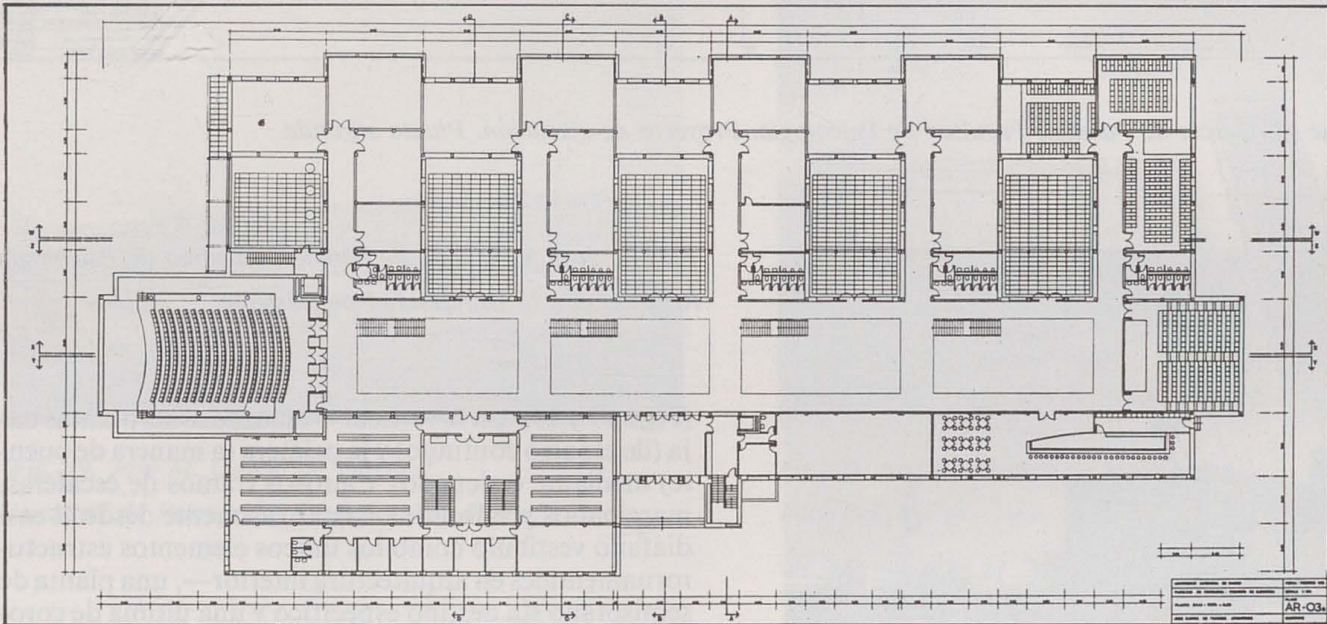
José M. García de Paredes: Facultad de Psicología. Proyecto de ejecución. Planta baja.
